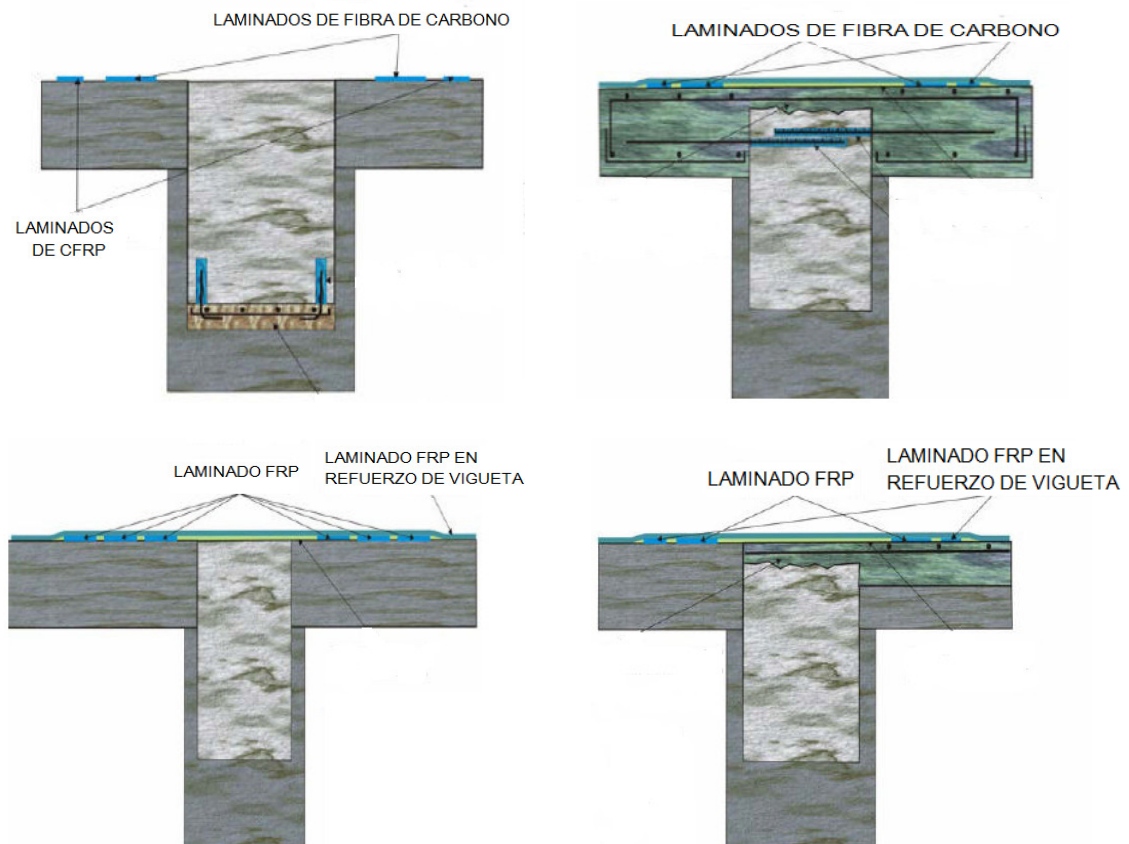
Diferentes secciones tipo para los refuerzos de las vigas.
